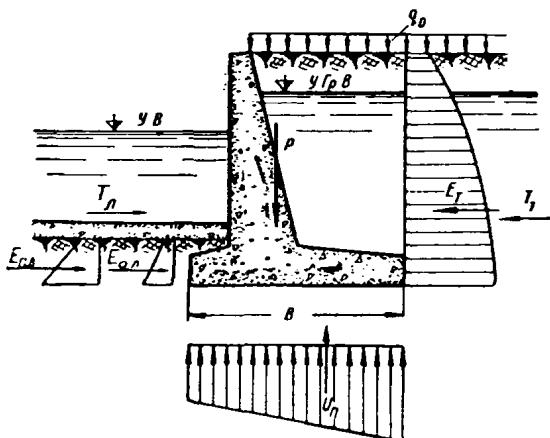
К расчету устойчивости подпорных стен на нескальных основаниях при горизонтальной плоскости скольжения
